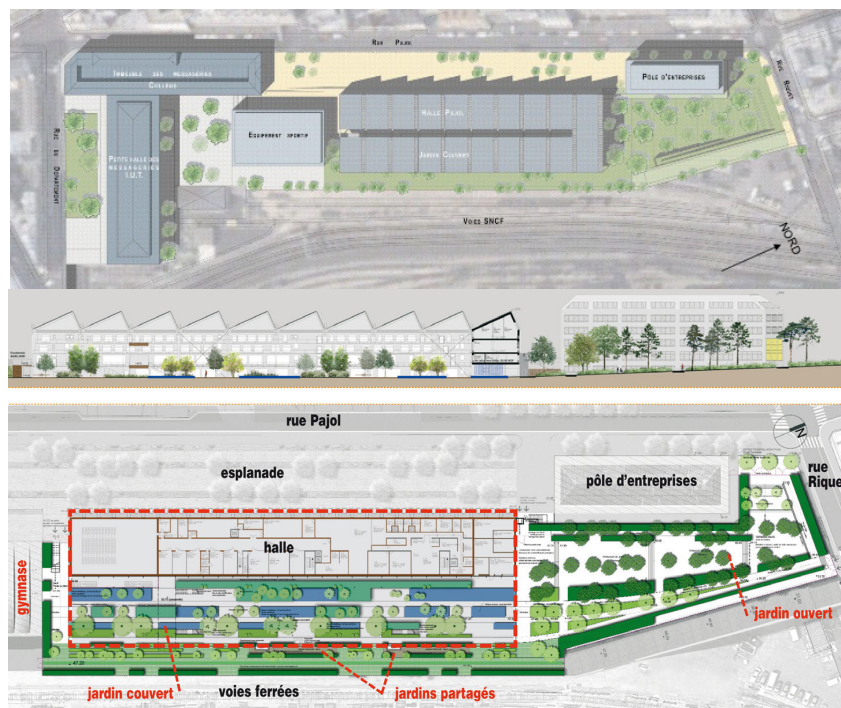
| Quartiere de *La Chapelle*, ZAC Pajol: planivolumetrico d'insieme e pianta e sezione della *Hall Pajol* e del giardino *Rosa Luxemburg*. Fonte: Ducloux P., Jean-William Souffront J-W. (2011), *ZAC Pajol: un projet exemplaire de quartier durable*, Mairie de Paris, SEMAEST, lagazette.fr, giugno.
